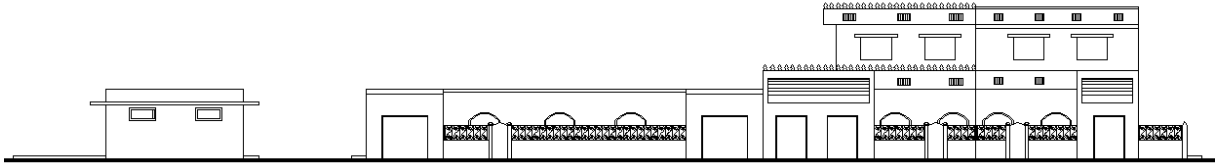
Façade Nord-est (place de la cité les Palmiers) dessinée sur Autodesk-Autocad.
